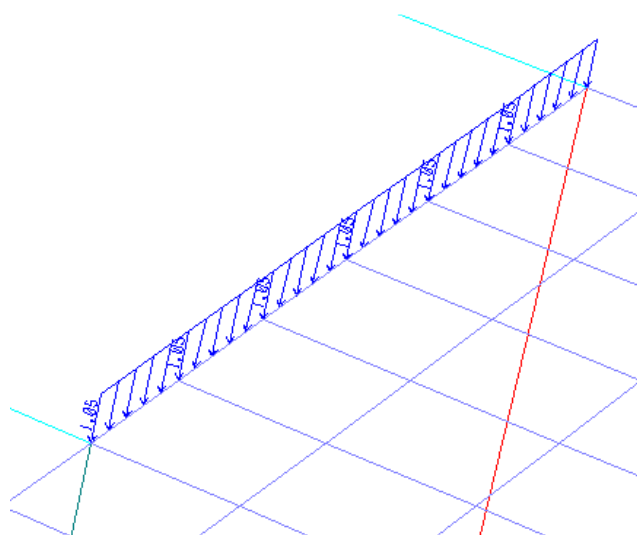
Reação de revestimento da escada na viga V4 via SAP2000
